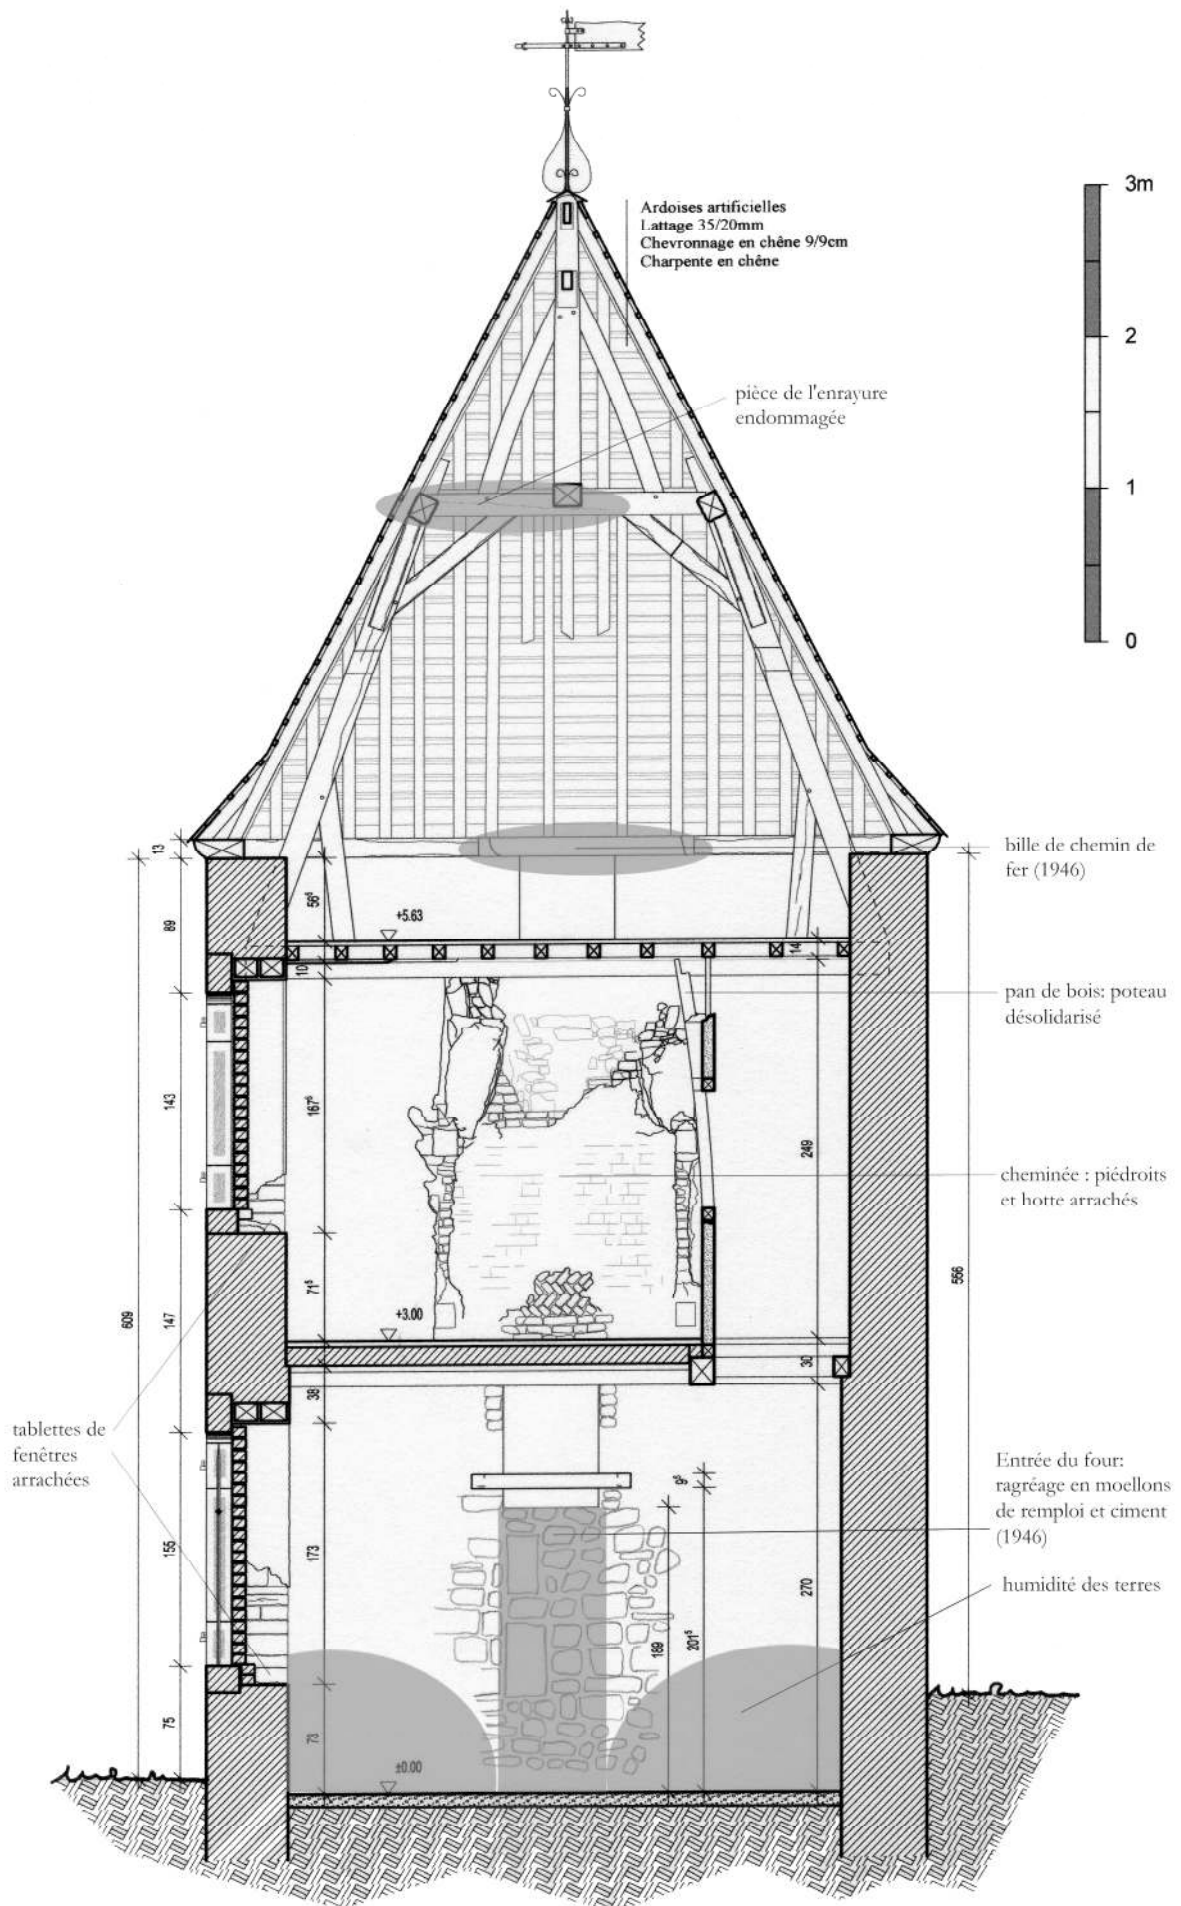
Pavillon. Vue en coupe AA'. Ech. 1/50°. Etat sanitaire. IG 2008.
